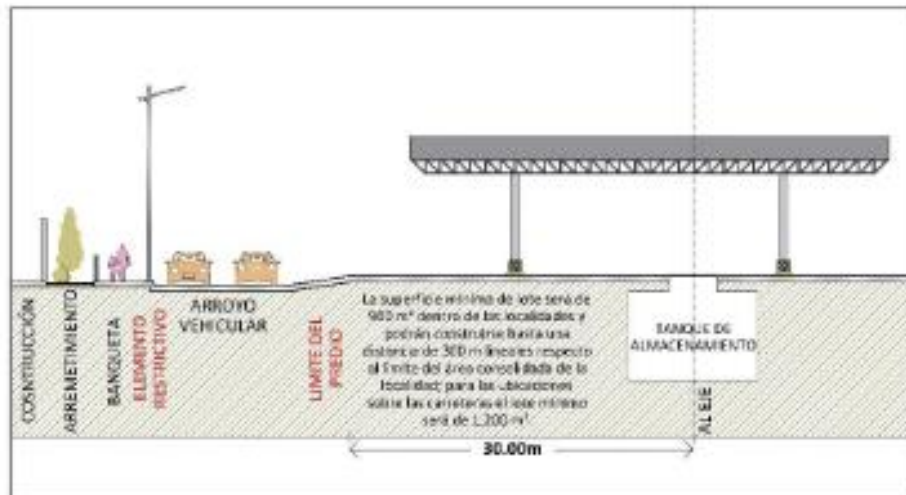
Elementos restrictivos para la construcción de Estación de Servicio y de Autoconsumo de Gasolina tipo A-1, A-2 y A-3.
